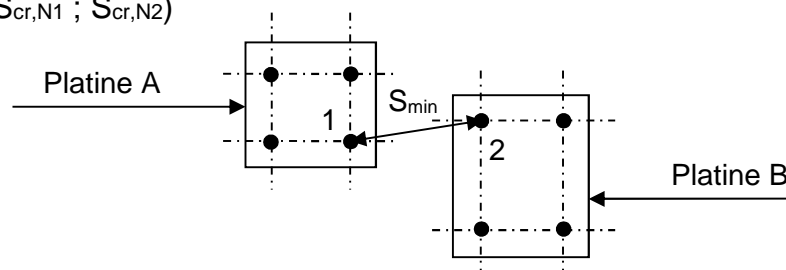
Distance minimale entre goujons à tête de dispositifs d'ancrage mitoyens
